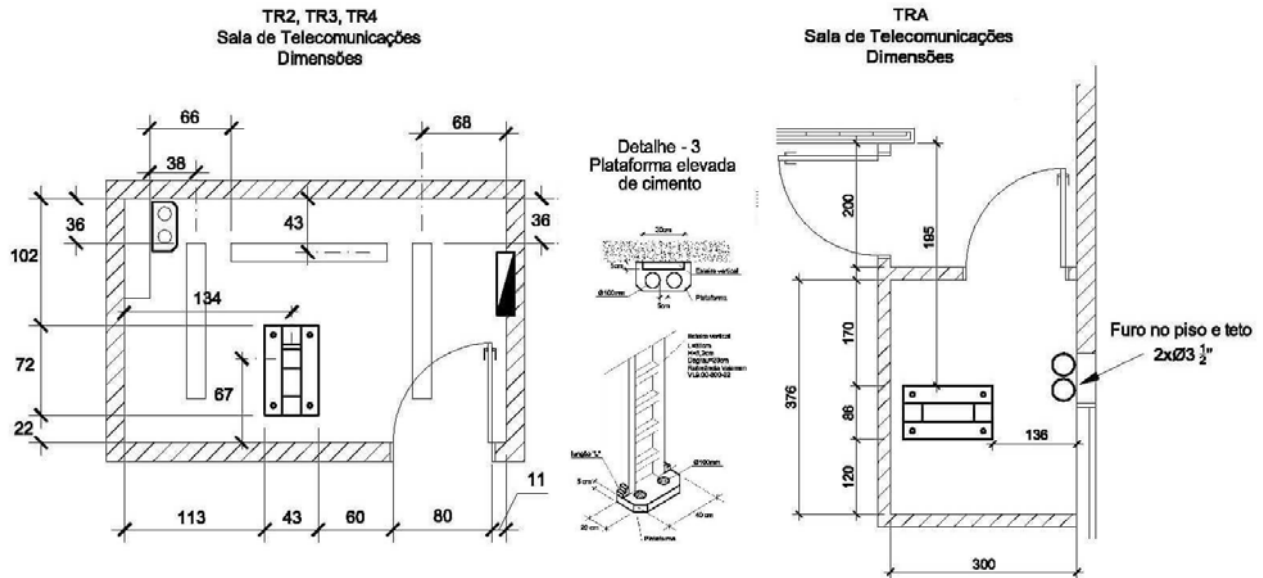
TR2, TR3, TR4 – dimensões e layout
